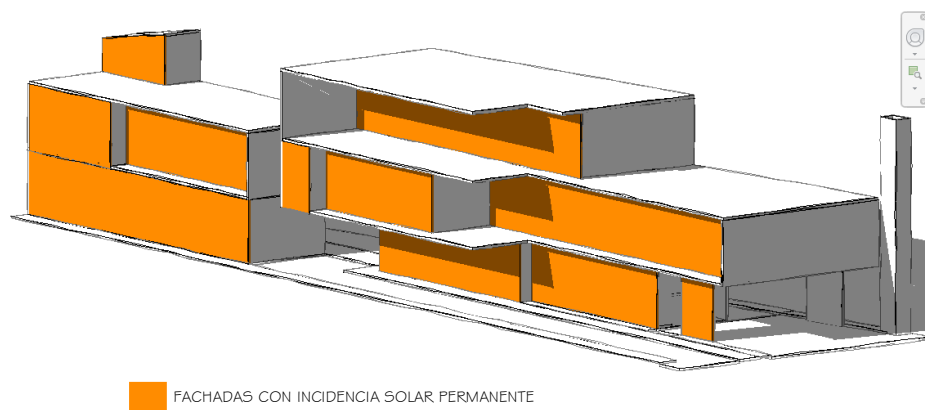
Fachadas con incidencia solar crítica. Fuente: Elaboración Propia.
